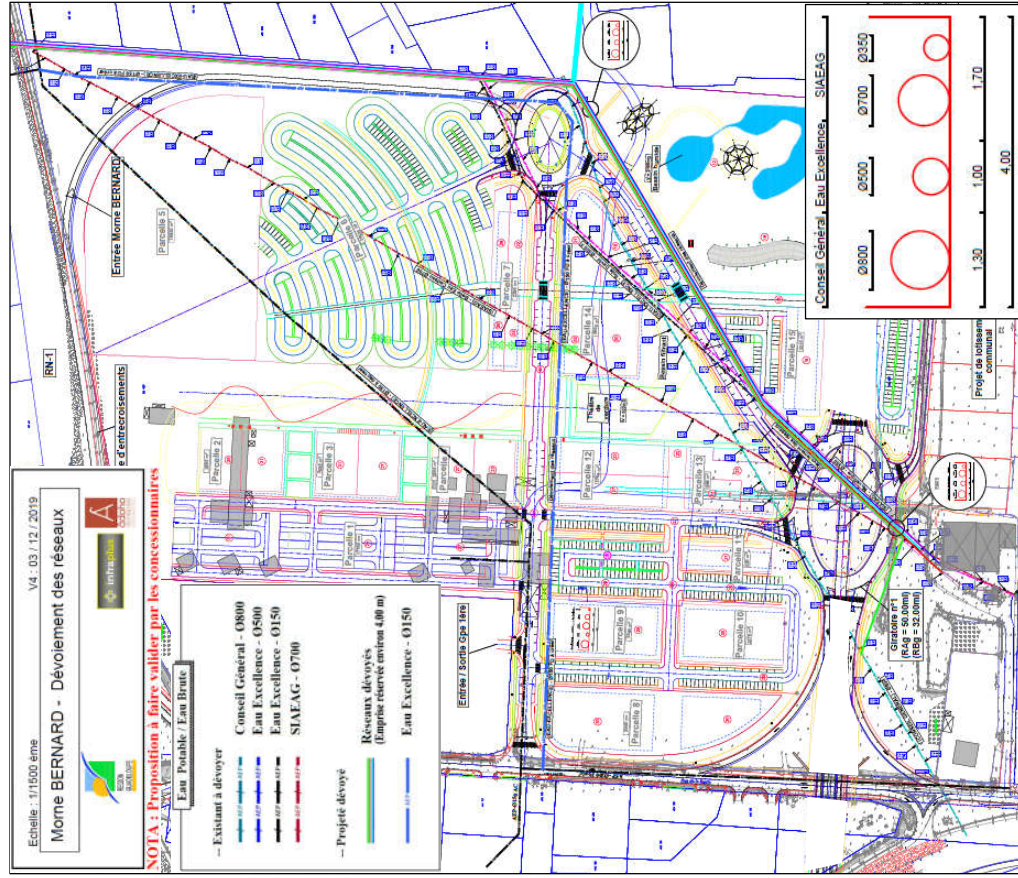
Plan de déviement des réseaux AEP existants sur le site. (Source : BET Infraplus)
